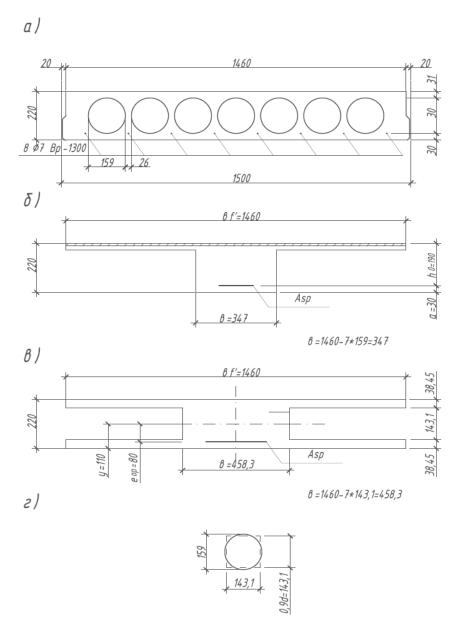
Поперечные сечения плиты с круглыми пустотами: a- основные размеры;  $\delta$ - к расчету по прочности;  $\epsilon$ - к расчету по второй группе предельных состояний;  $\epsilon$ - к расчету эквивалентного сечения
